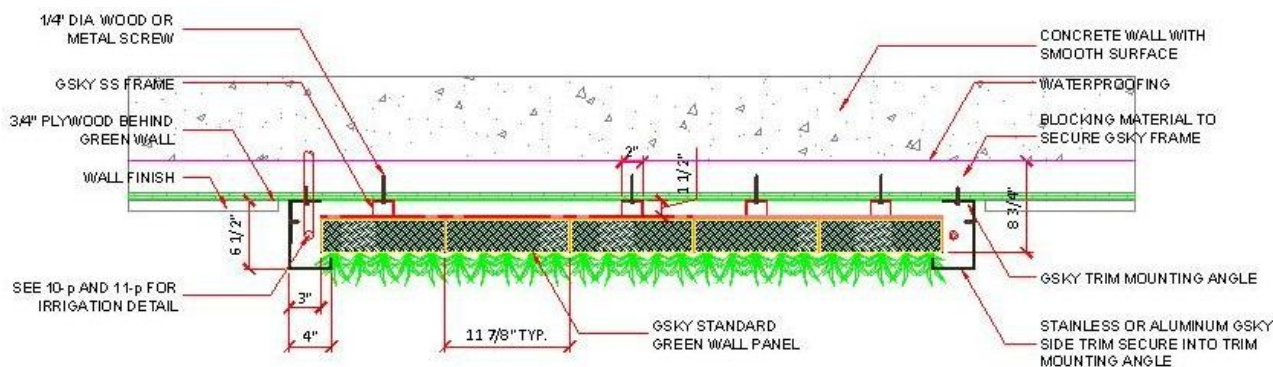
Secció longitudinal del sistema Green Wall Panels [39]
